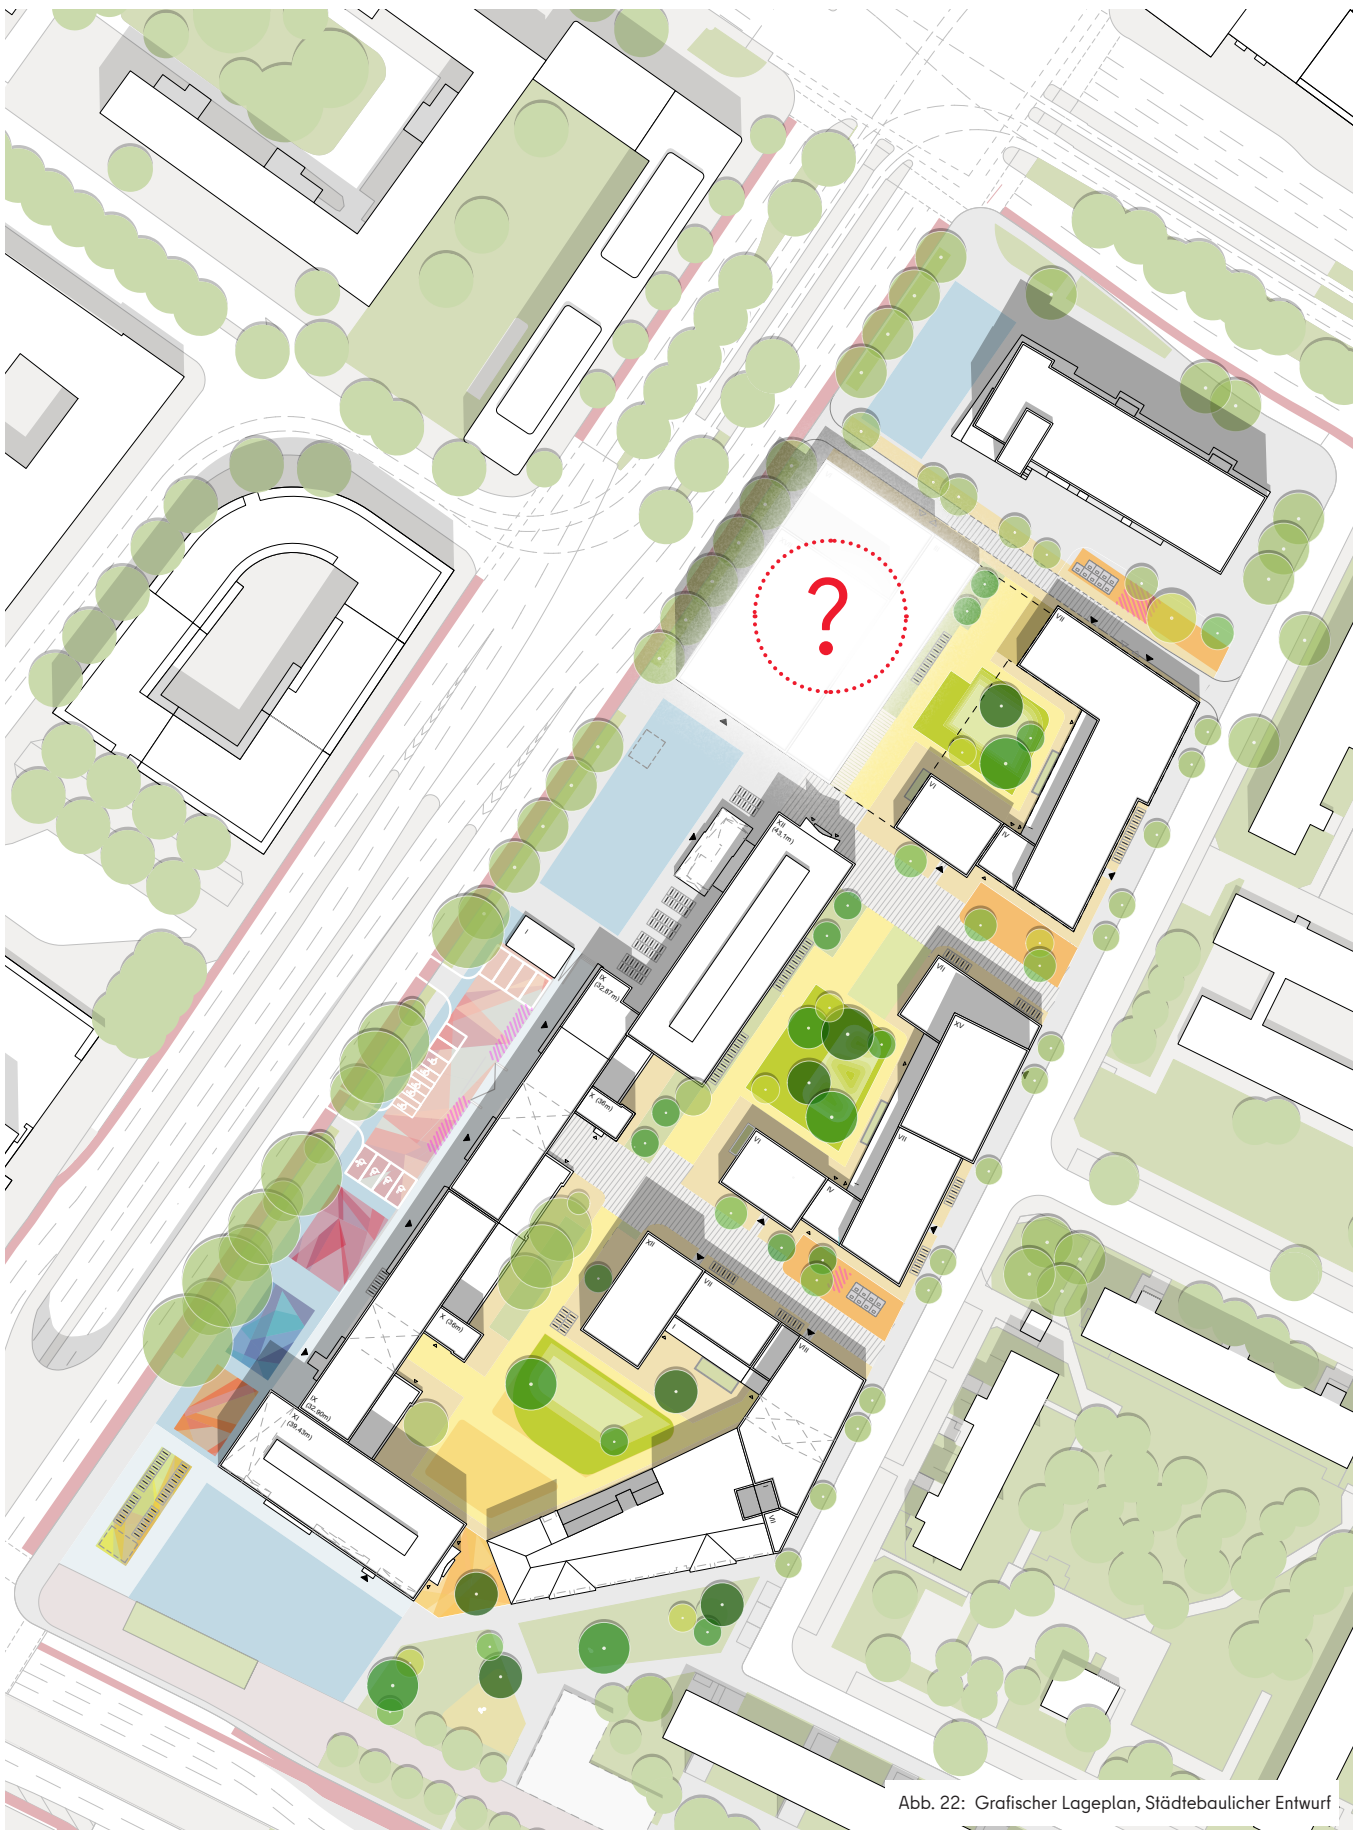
Grafischer Lageplan, Städtebaulicher Entwurf
